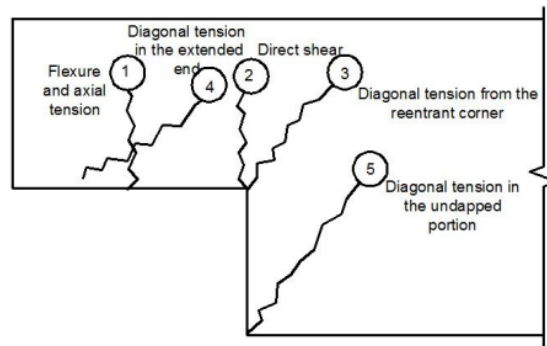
Fissures rencontrées au sein d'une poutre "dapped-end" [52]
